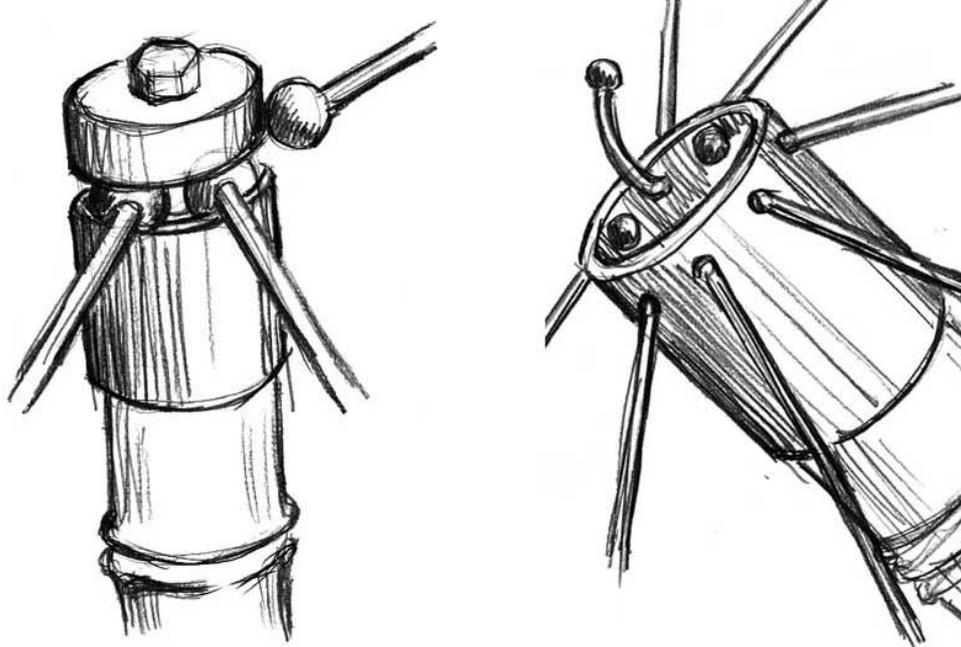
Fixador 5 - Com hastes conectoras deslizantes. Fixador 6 - Anel de metal preso por pressão com furação no topo, para ancoragem dos cabos (desenhos do autor).
